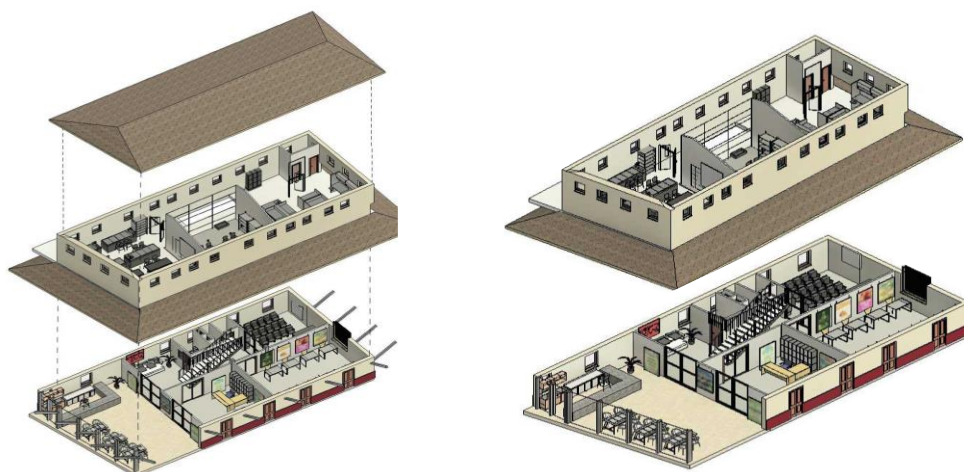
Planta arquitectónica del primer y segundo nivel estación de tren “La Laguna”
